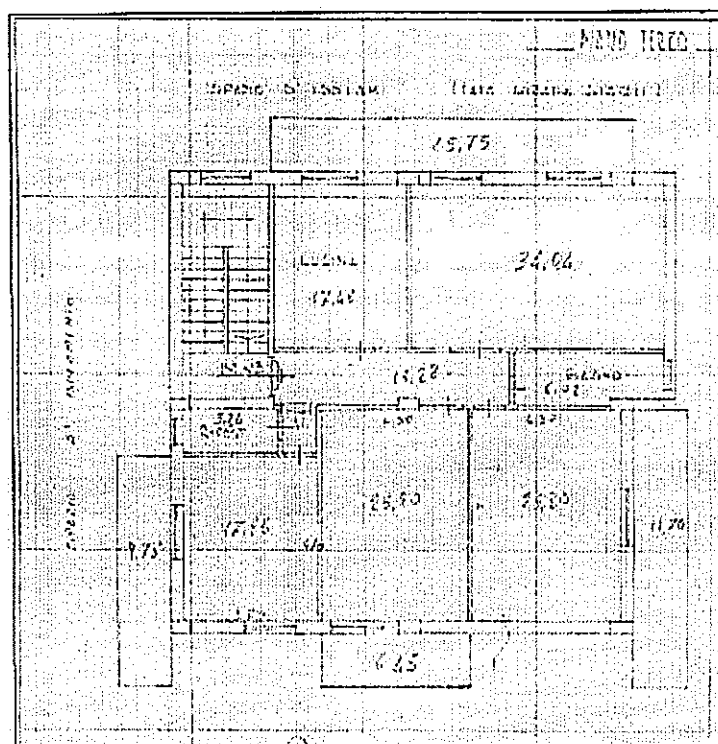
Planimetria distributiva del piano terzo (sub. 6) della part. 1050
